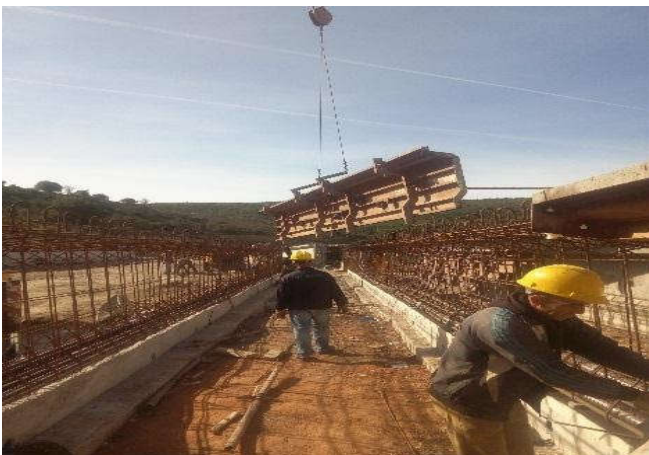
Pose du coffrage de la poutre précontrainte
